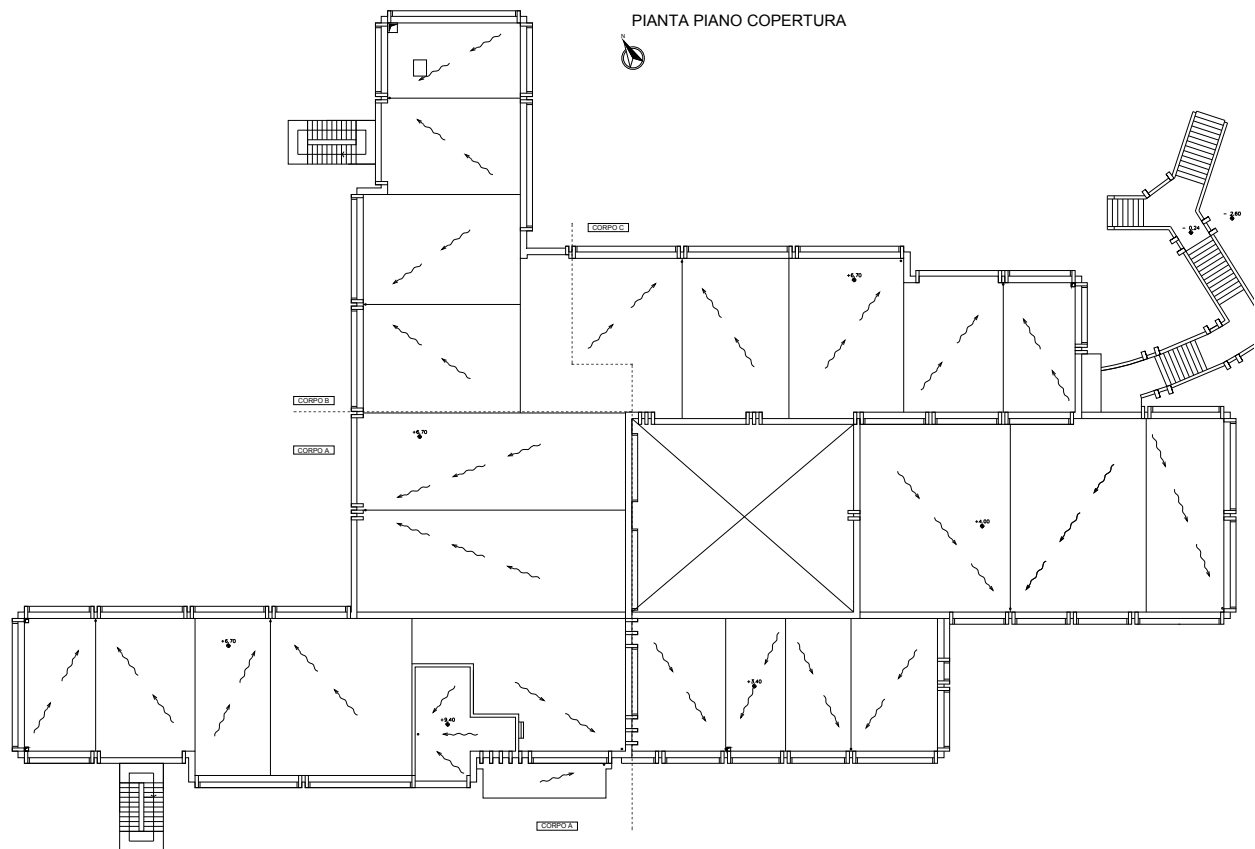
Pianta Piano Coperture – Stato Futuro
